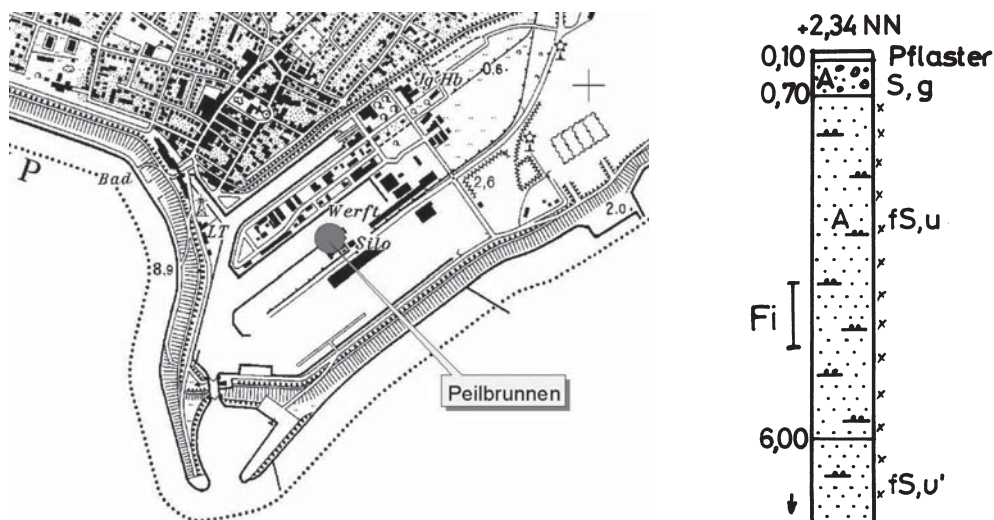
Lageplan mit Bohrprofil Hafen Būsum
